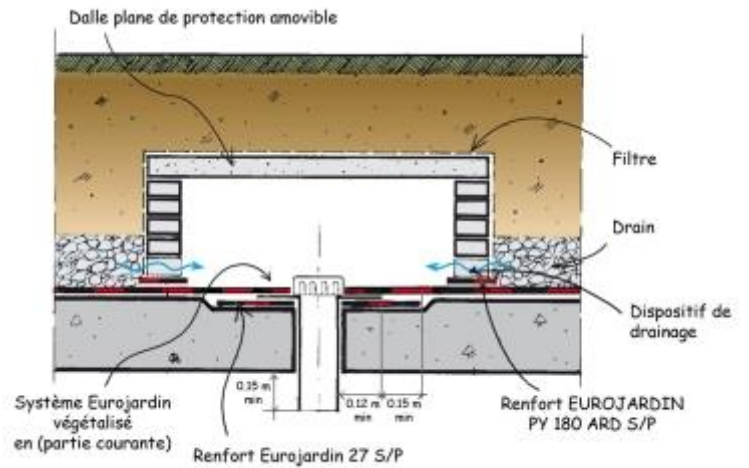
Entrée d'eaux pluviales toitures-terrasses jardins
